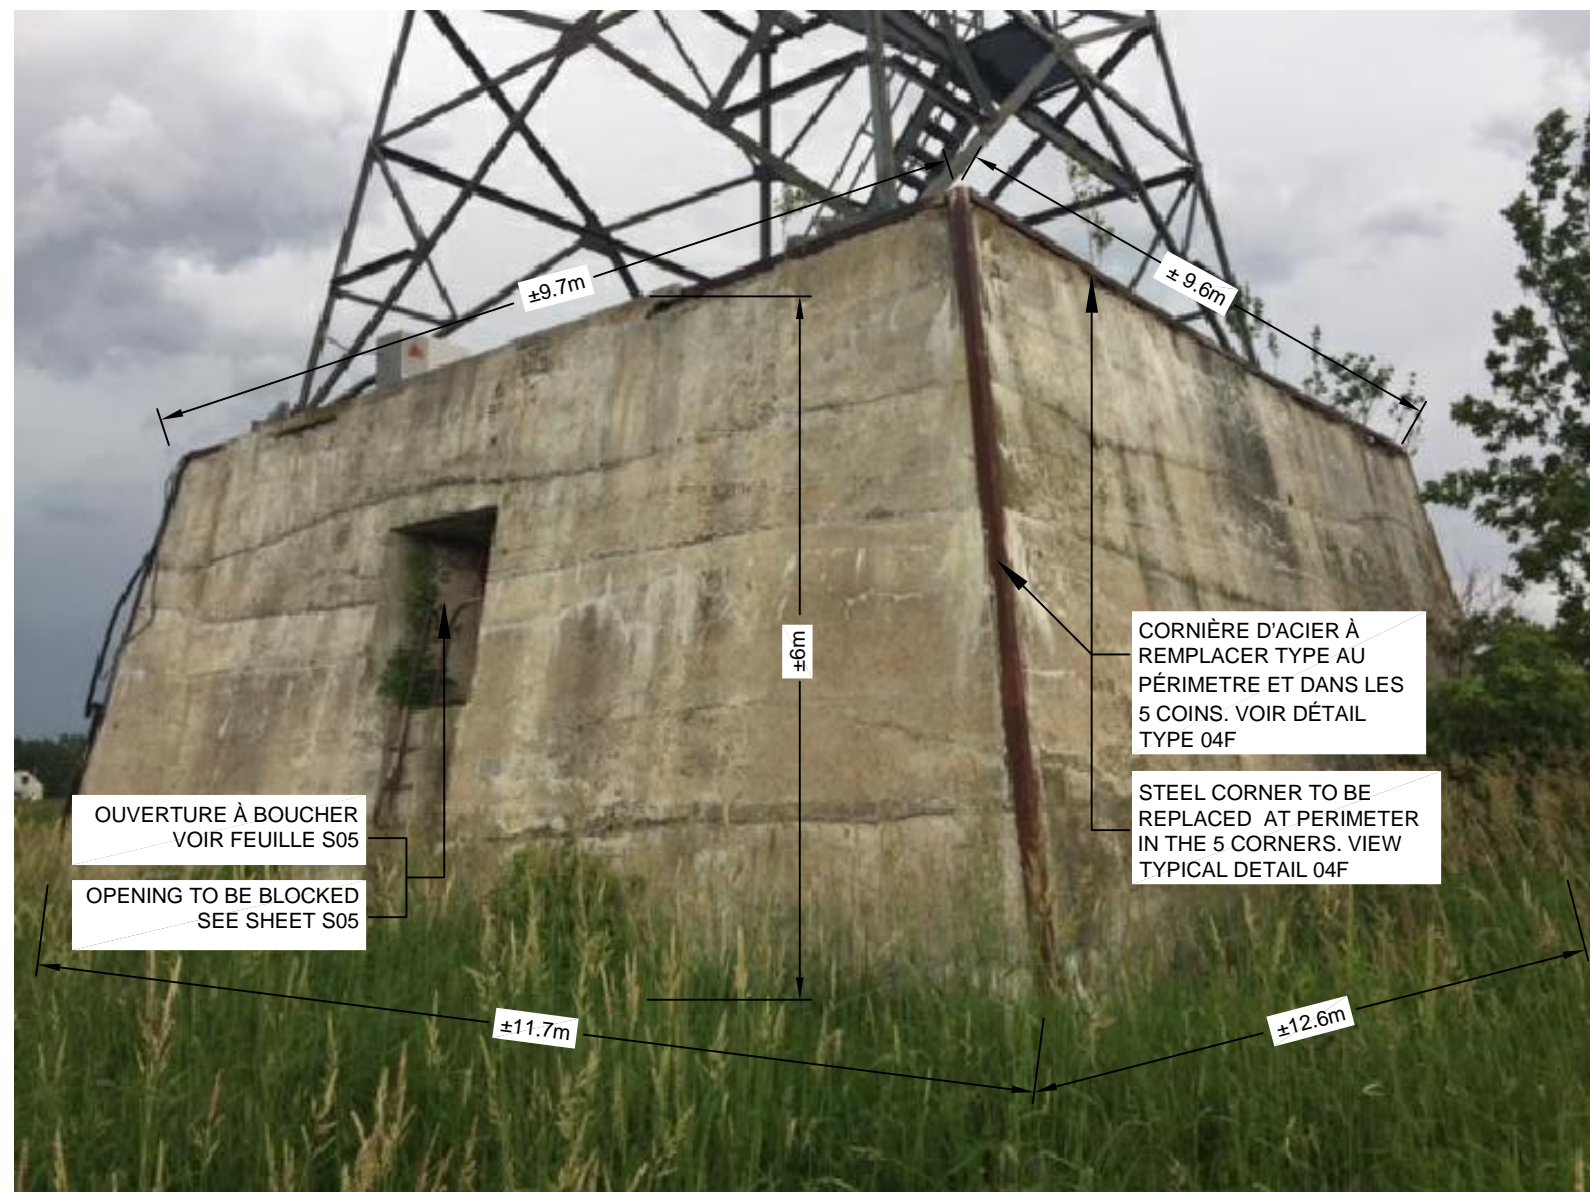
DIMENSIONS GÉNÉRALES DU PILIER COIN "NORD-EST" /
